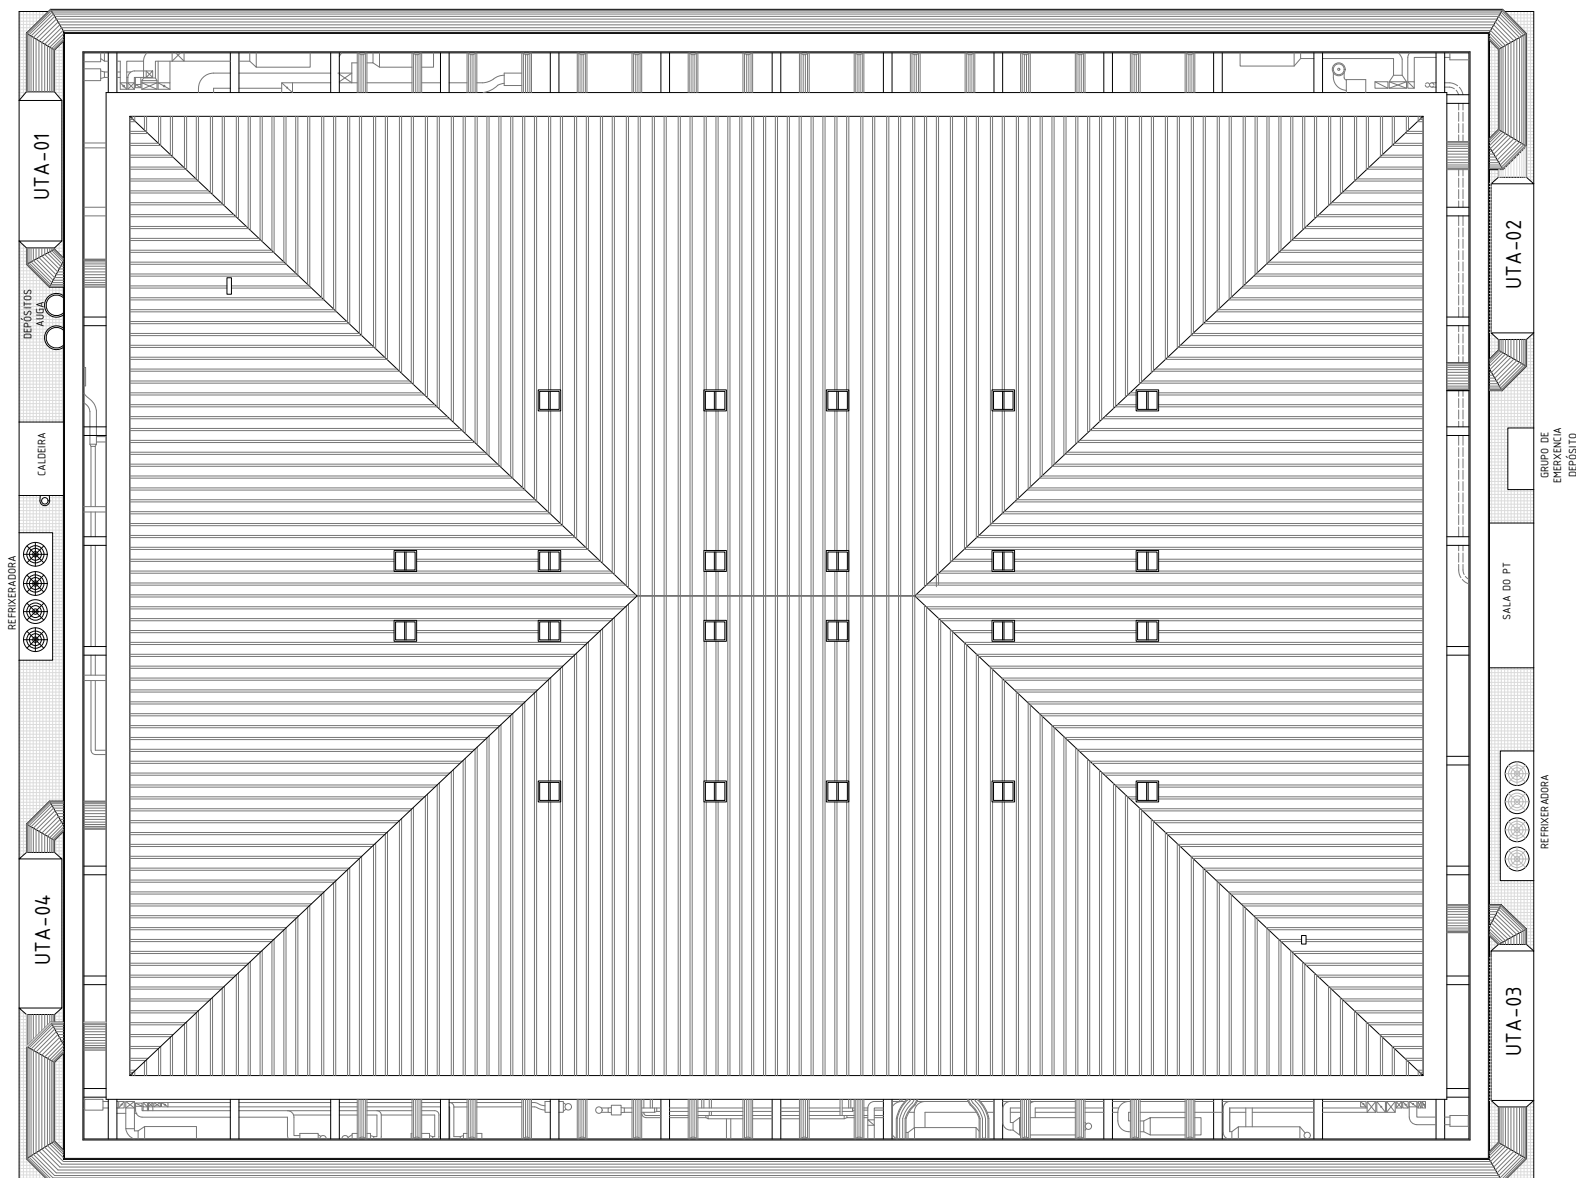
Planta de cubertas do Centro Cultural. Escala 1/350.
